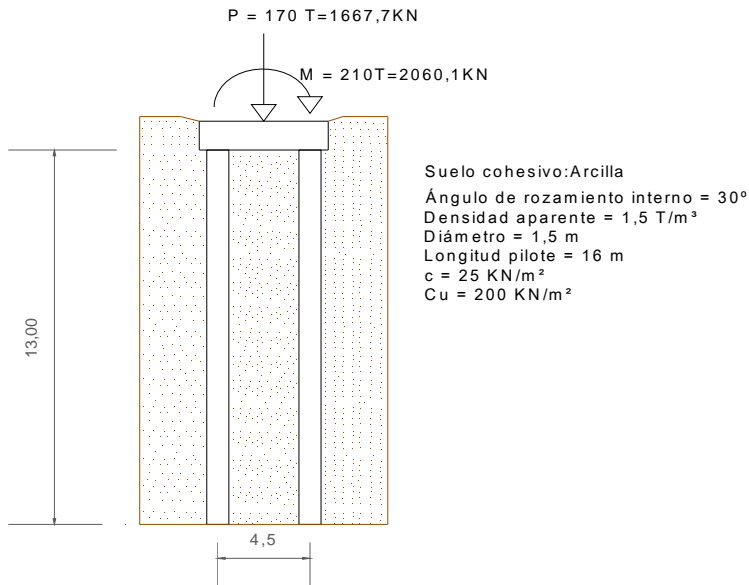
Croquis de grupo de 2 pilotes con diámetro 1,5 m y longitud pilote 13 m
